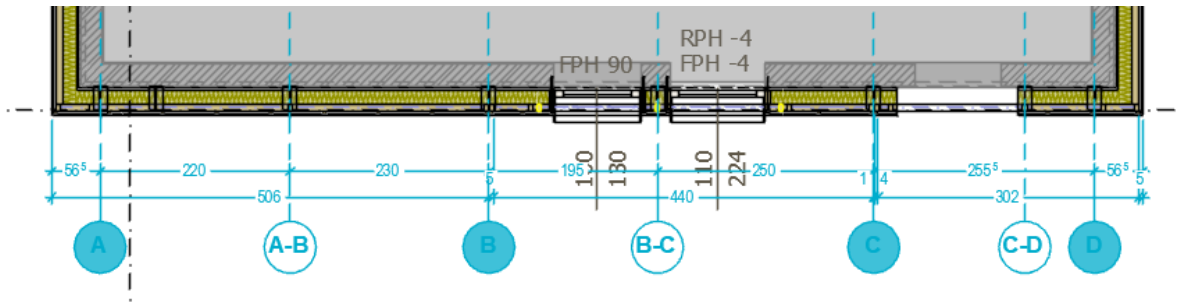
/ Grundriss nach Montage Fenster- Türelemente
